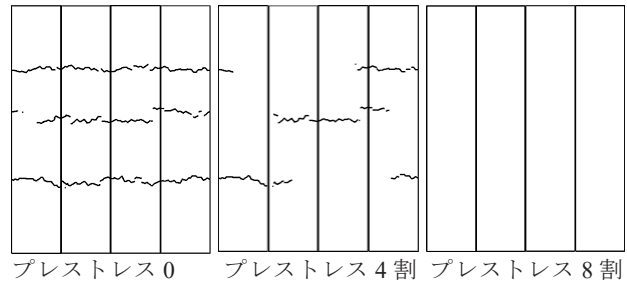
鋼材降伏時の表面ひび割れ展開図
